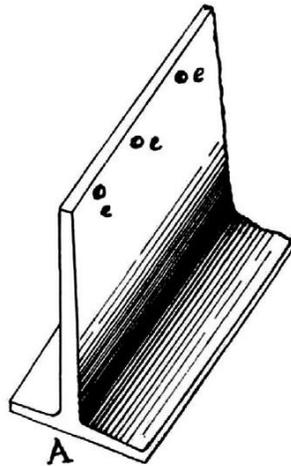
Vigas de acero en "T" invertidas que en sus pestañas recibían las losas de concreto prefabricado.
